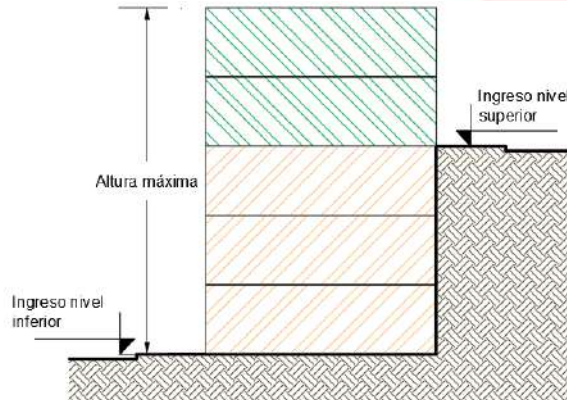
Altura máxima en terrenos con desnivel y doble acceso
